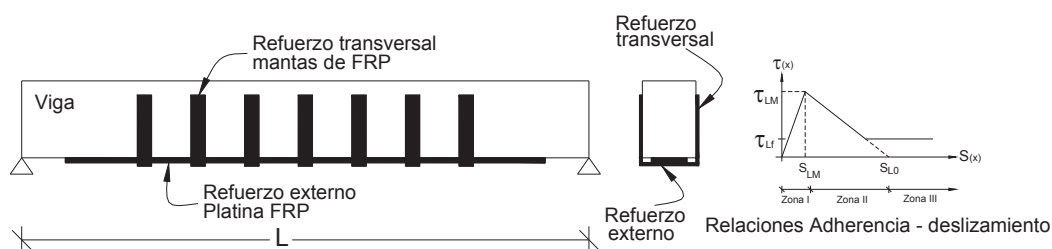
Refuerzo transversal para el incremento de la adherencia entre la platina FRP y el sustrato de concreto.
